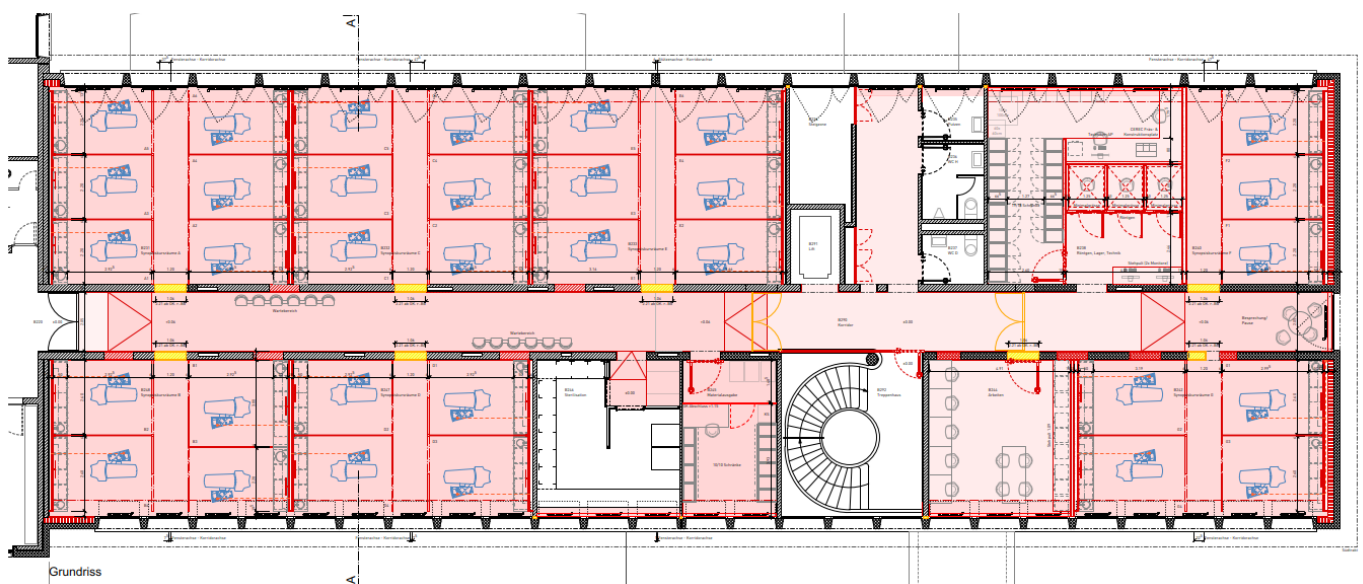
Neues Grundrisslayout mit 33 Behandlungskojen
